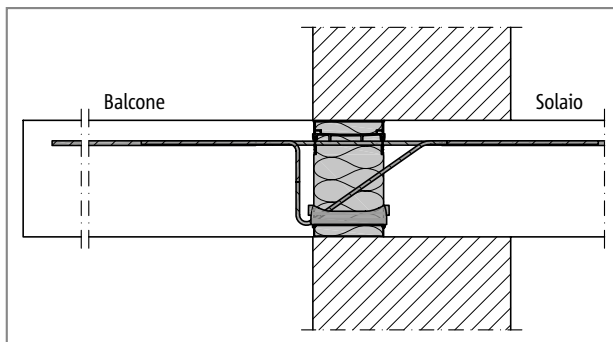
Schöck Isokorb® tipo KXT: raccordo con appoggio su muratura monostrato
